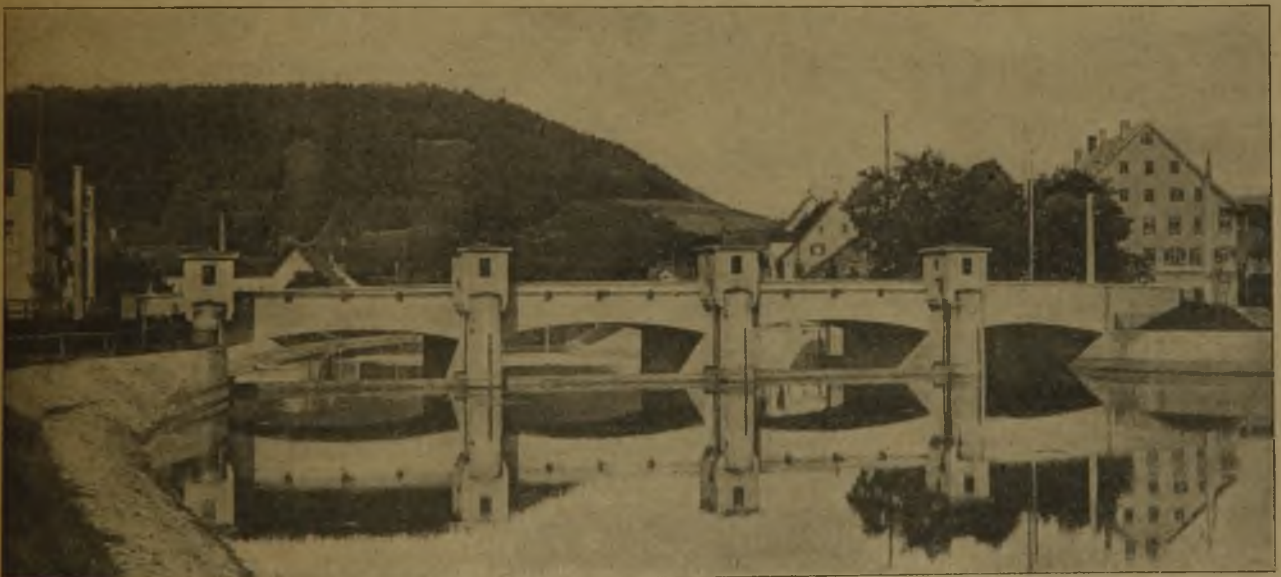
Donaubrücke in Tuttlingen in Verbindung mit Wehr. Ansicht von oberhalb.
